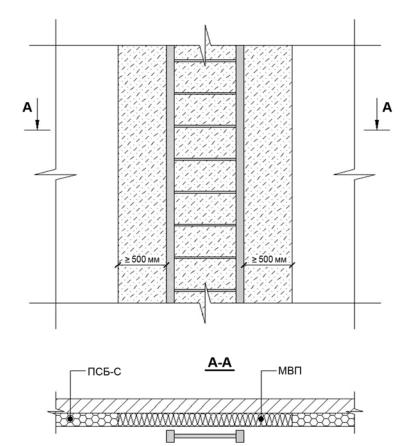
Участки примыкания СФТК к пожарной или наружной маршевой лестнице здания
